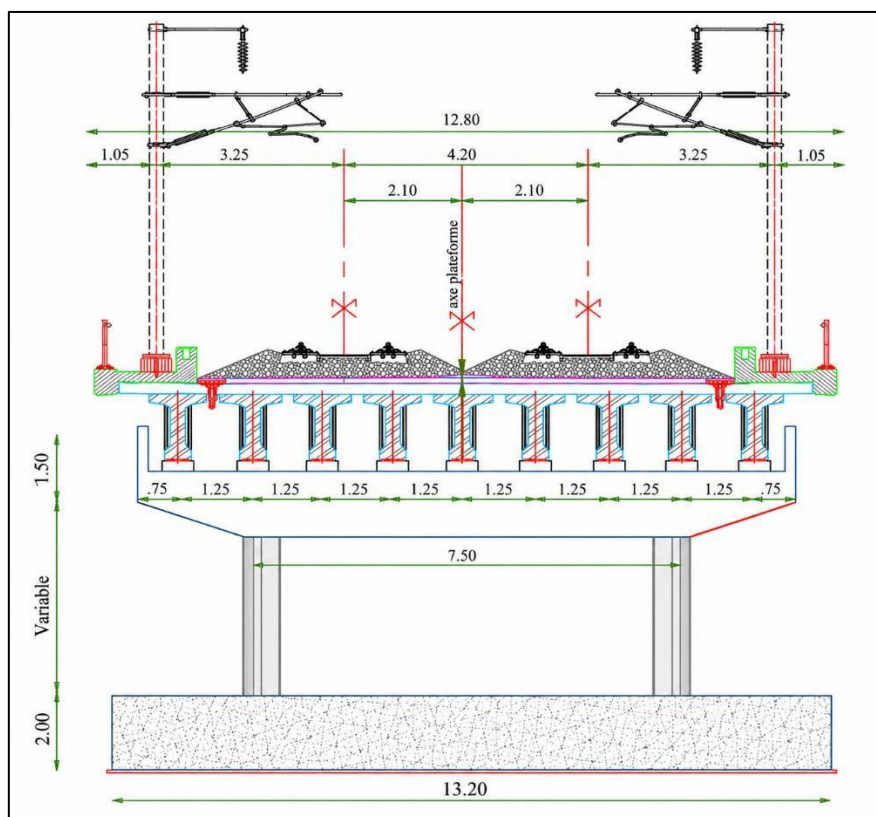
Coupe transversale sur pile OA PK 27+880
